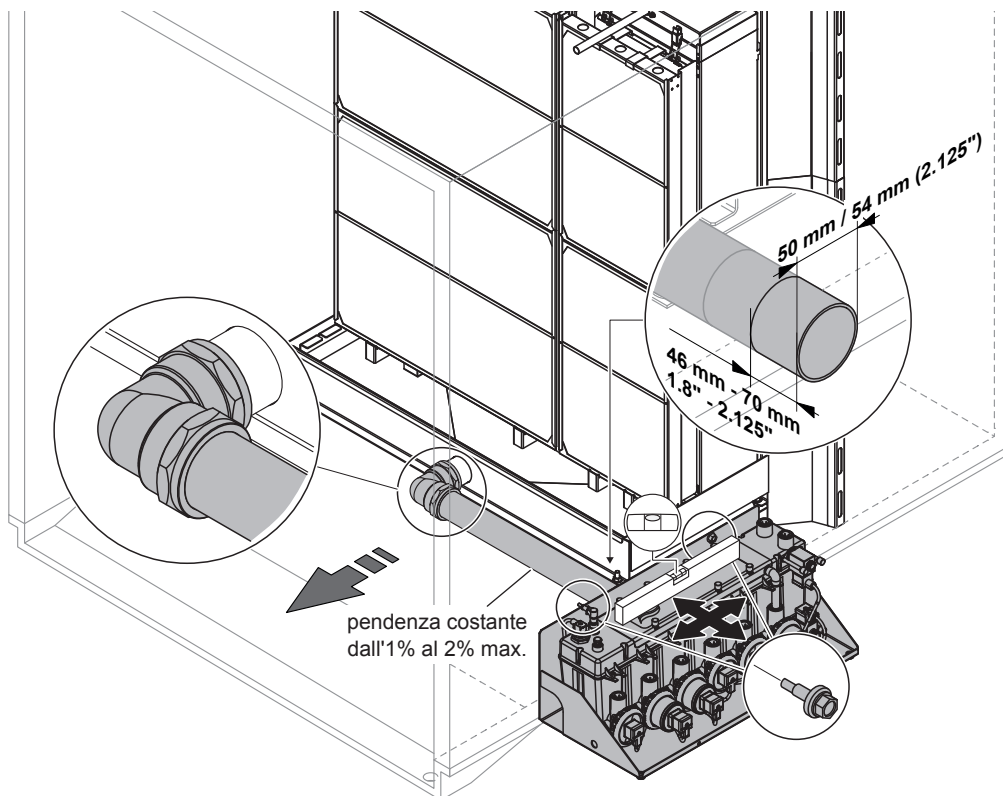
Montaggio del modulo idraulico (installazione esterna, vasca con drenaggio centrale)
